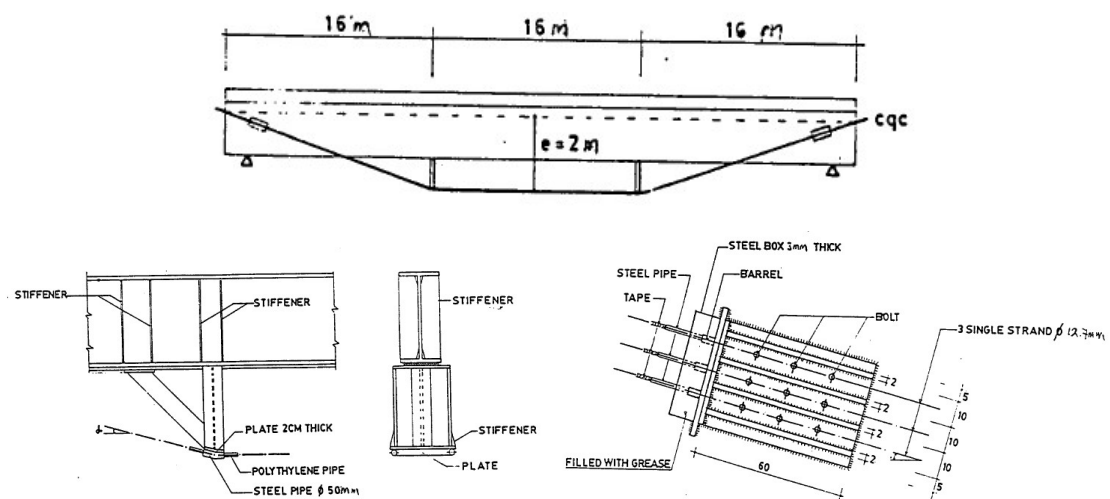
Vista inferior e detalhe ancoragem dos cabos na Ponte de Condet
